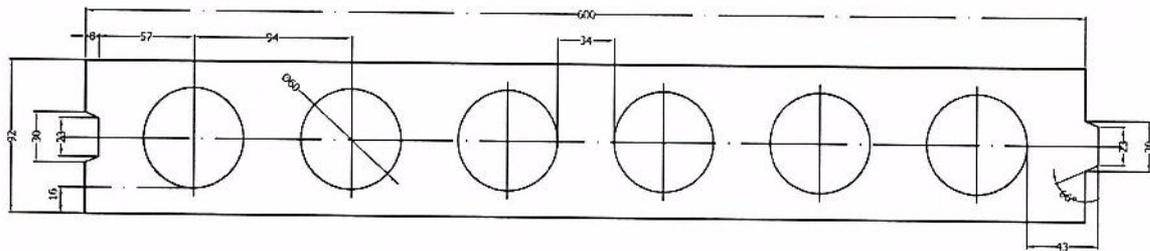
Detalle constructivo del panel WSG 92 (aportado por el peticionario)
